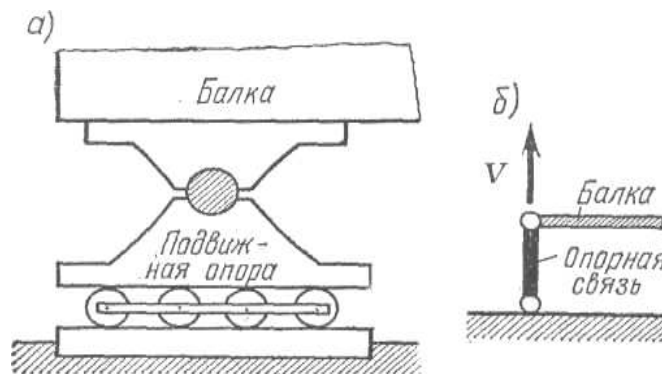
Шарнирно-подвижная опора: *а* – вид опоры;
